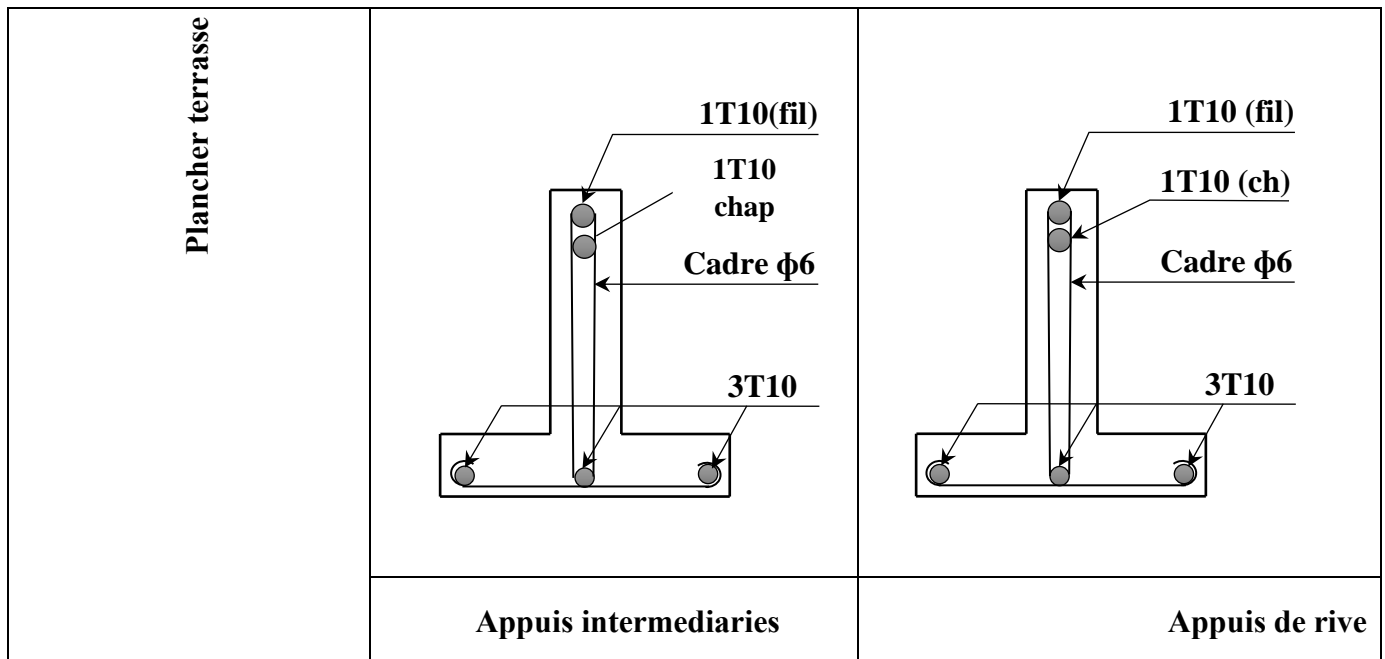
Dessin de ferrailage des poutrelles plancher terrasse
